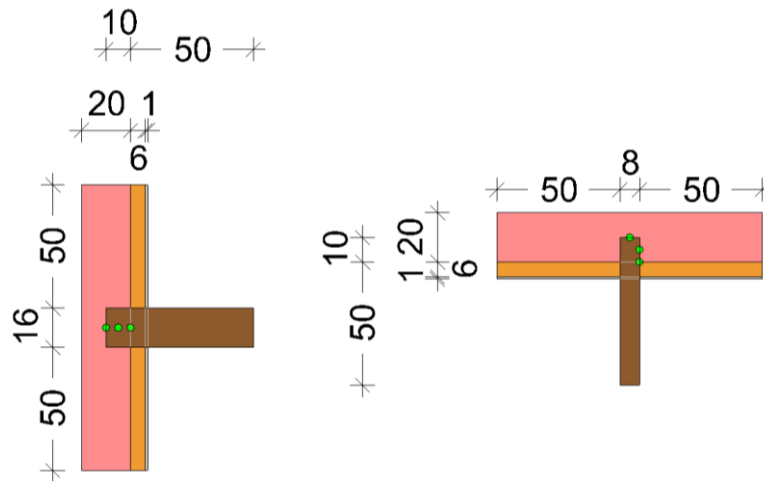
Links Vertikalschnitt, rechts Grundriss
